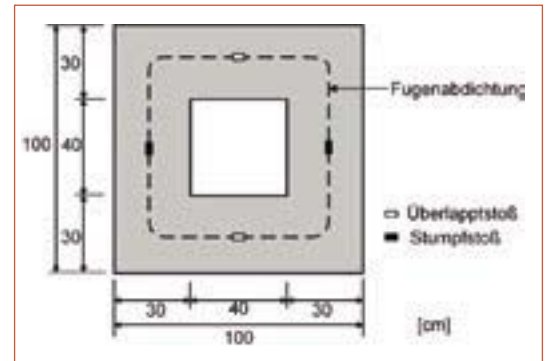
Versuchsaufbau für die Funktionsprüfung beim Flex 15 Q NB bzw. A 15 Q NB (Grundriss)
